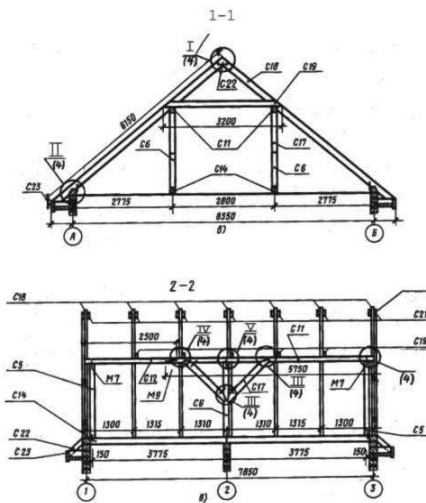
Размеры по схеме стропил: б – 1-1; в – 2-2
